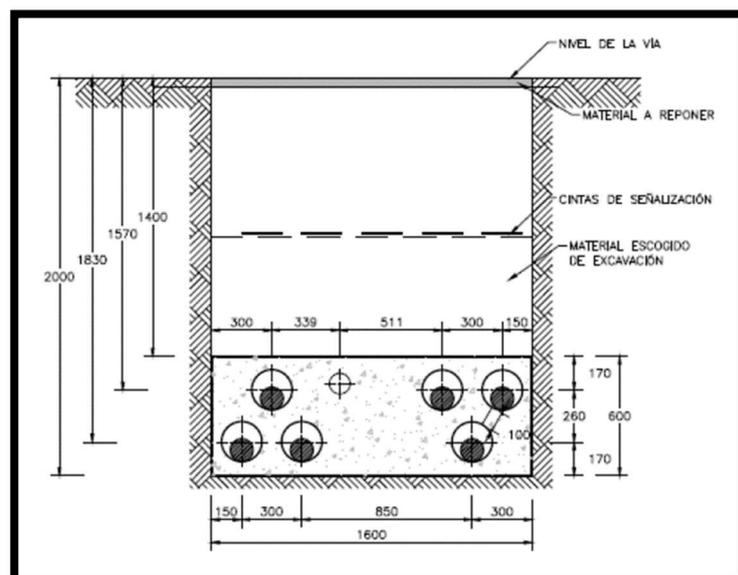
SECCIÓN DEL ENDUCTADO DE CONCRETO.
